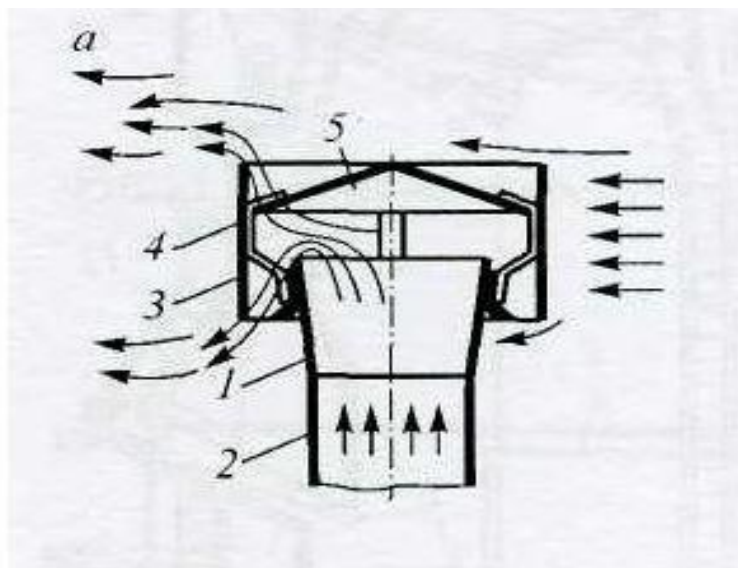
Схема дефлектора: 1 – патрубок; 2 – витяжний канал; 3 – корпус дефлектора; 4 – кріплення зонта – ковпака; 5 – зонт – ковпак.
